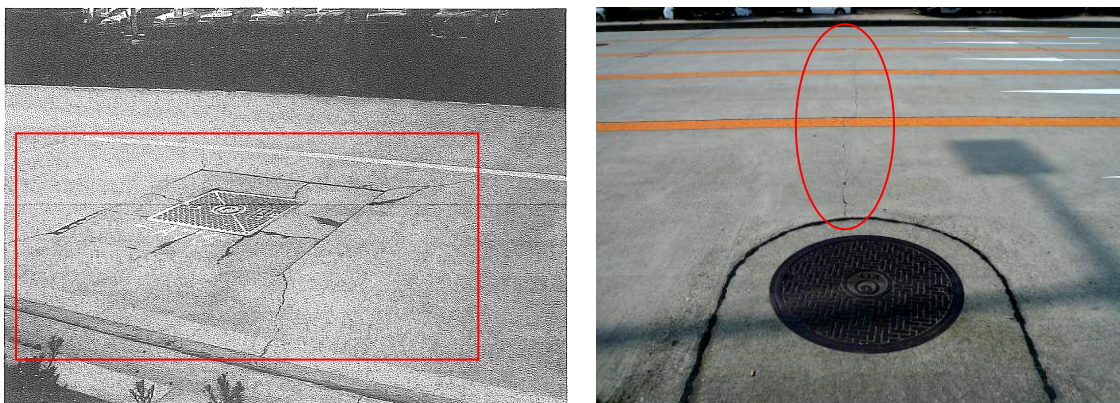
隣接構造物境界とのひび割れの例²⁾
